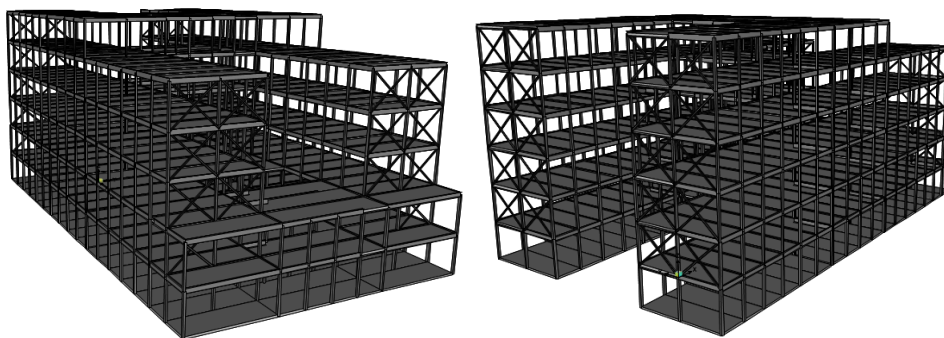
Modelo estructural del edificio ETSITGC creado en SAP2000. A la izquierda, se muestra la fachada este (fachada principal del edificio) y, a la derecha, la fachada oeste (fachada trasera del edificio).
